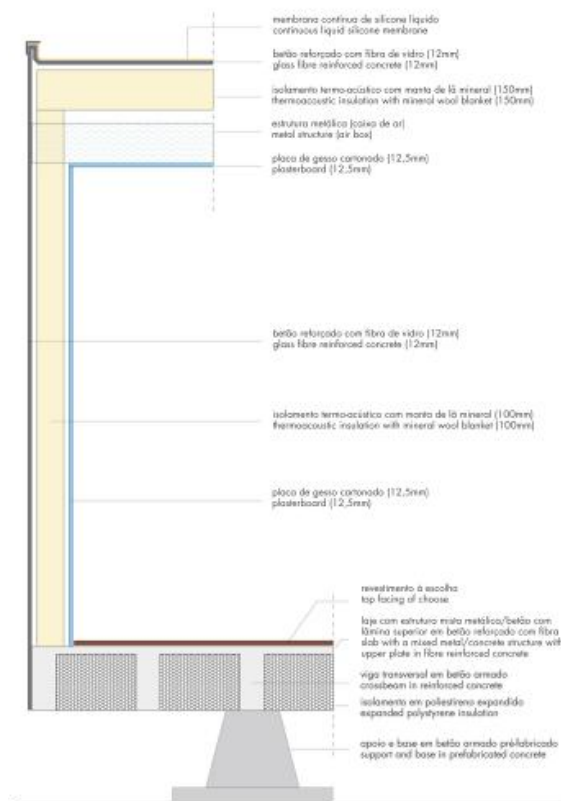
Pormenor Construtivo do Sistema S.I.T.
